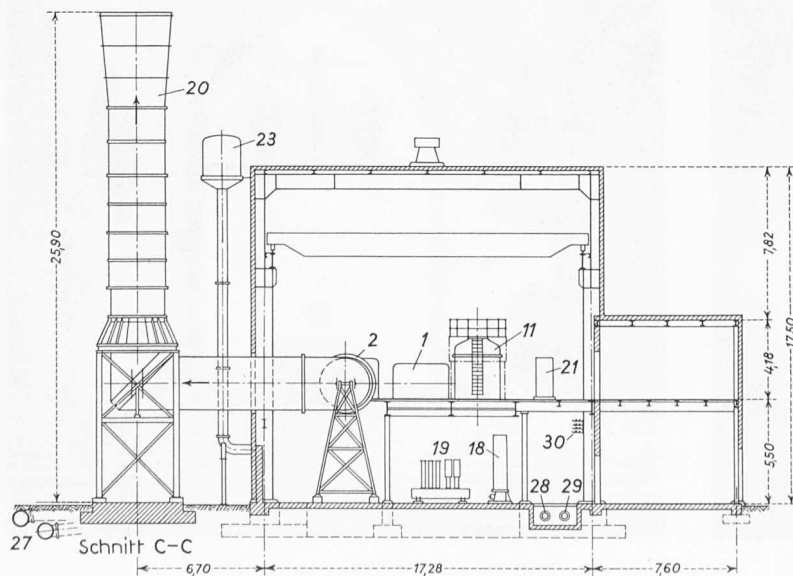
(Fortsetzung von Bild 2a). Längsschnitt und Grundriss der Maschinengruppen, 1:400
